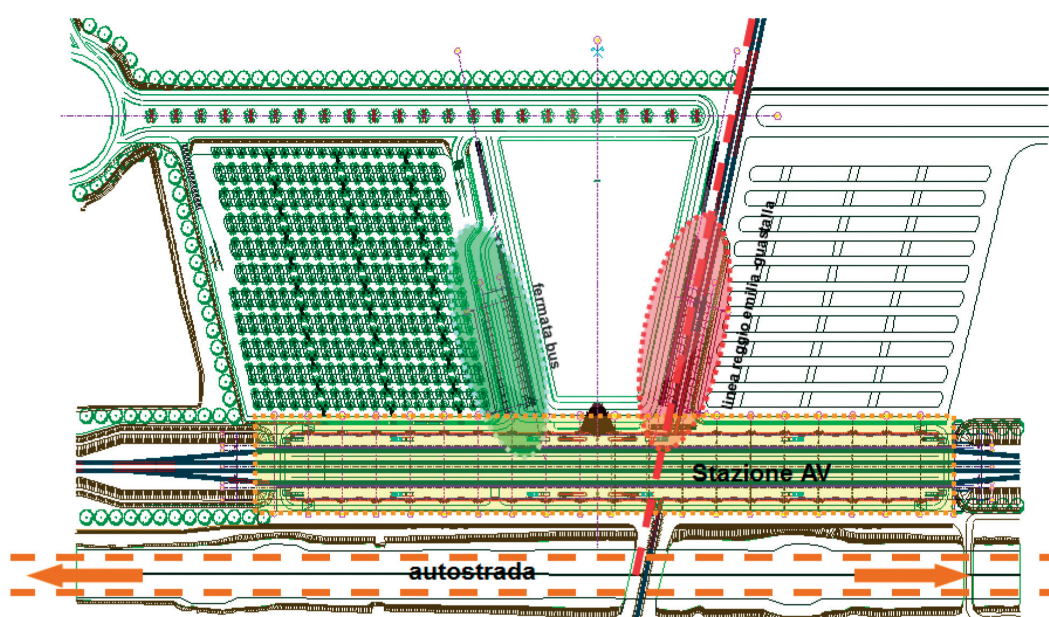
La pianta generale evidenzia la posizione della stazione, il suo sviluppo parallelo al tracciato autostradale e la nuova sistemazione degli spazi pertinenti e servizi sussidiari esterni. Si distinguono in prossimità dell'ingresso alla stazione le pensiline per la stazione dei bus e della fermata ferroviaria della linea regionale, la sistemazione del parcheggio accanto alla stazione.
